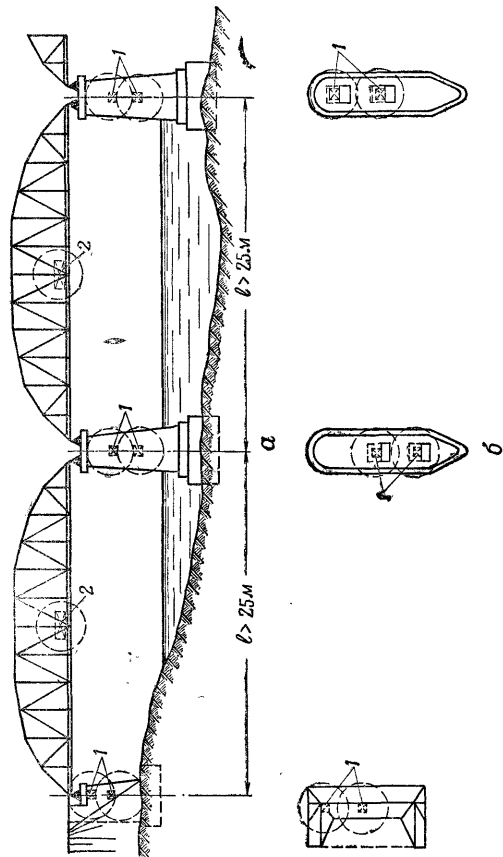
Подрывание металлического моста разрезной конструкции с пролетами более 25,0 м: а — вид сбоку; б — план (после подрыва); 1 — заряды в опорах; 2 — заряды на поясах ферм
